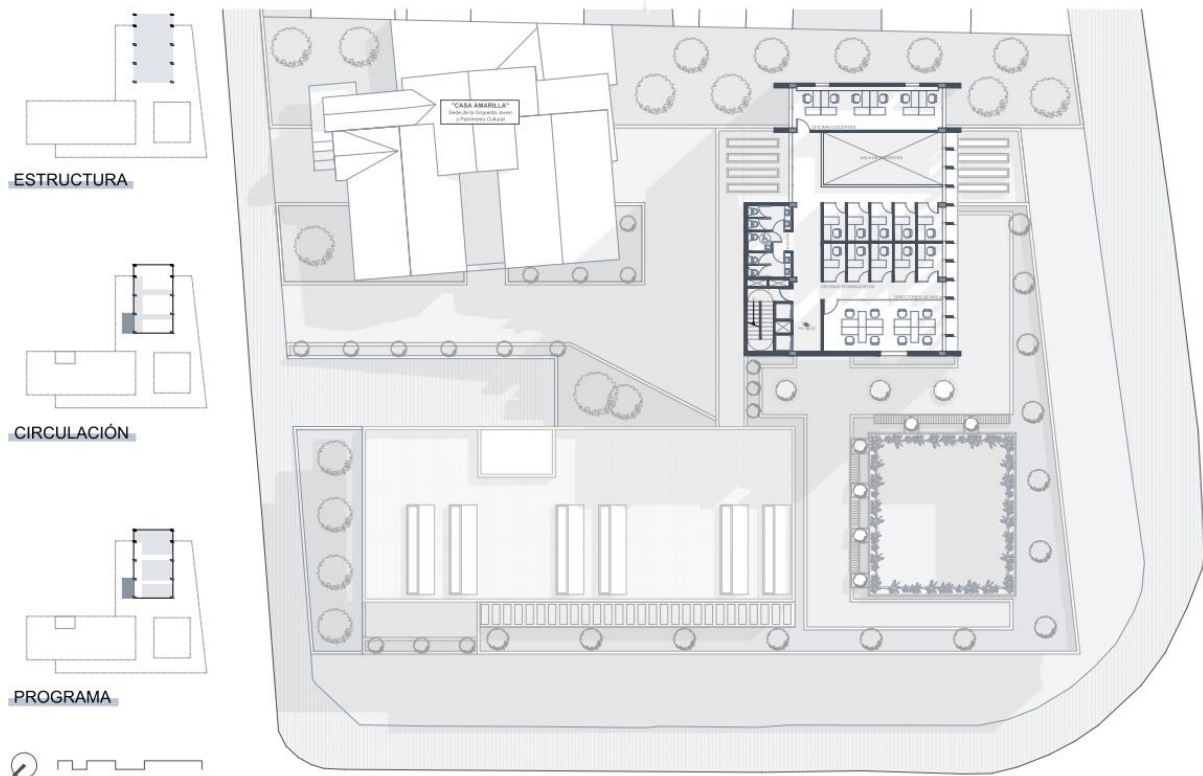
Planimetría: Planta Alta 7 (N+28,00)
